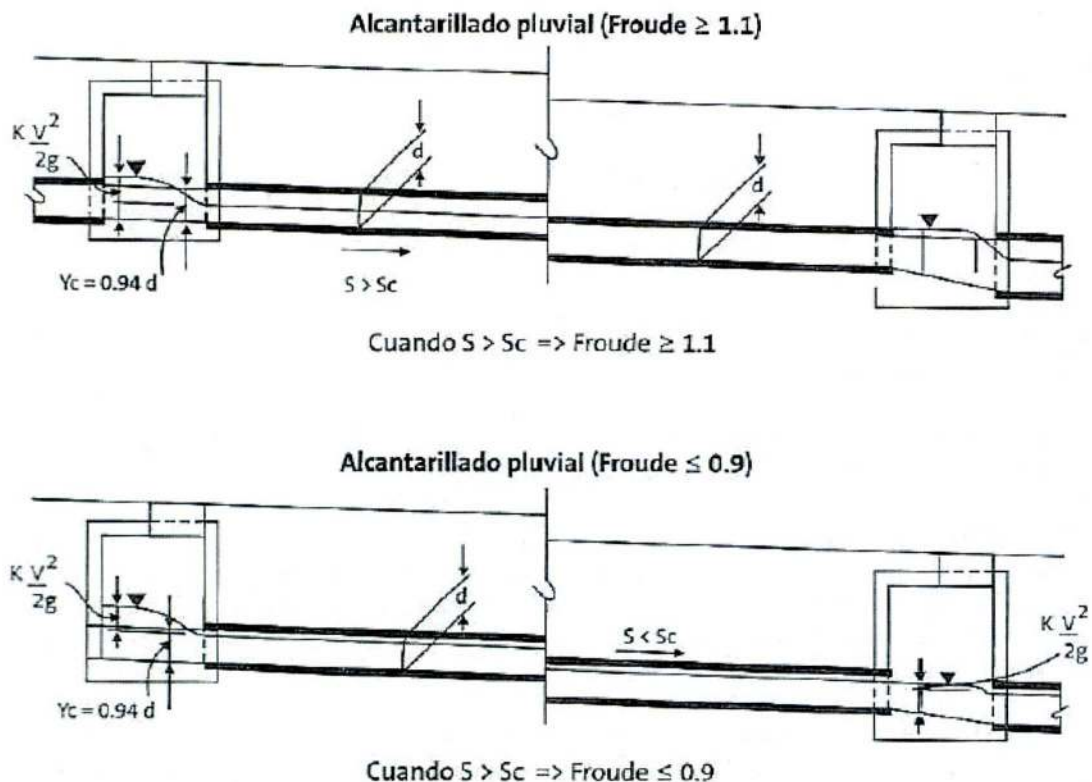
Detalle alcantarillado pluvial. (Fuente: Manual técnico Productos de Concreto, Décimo Quinta Edición)
